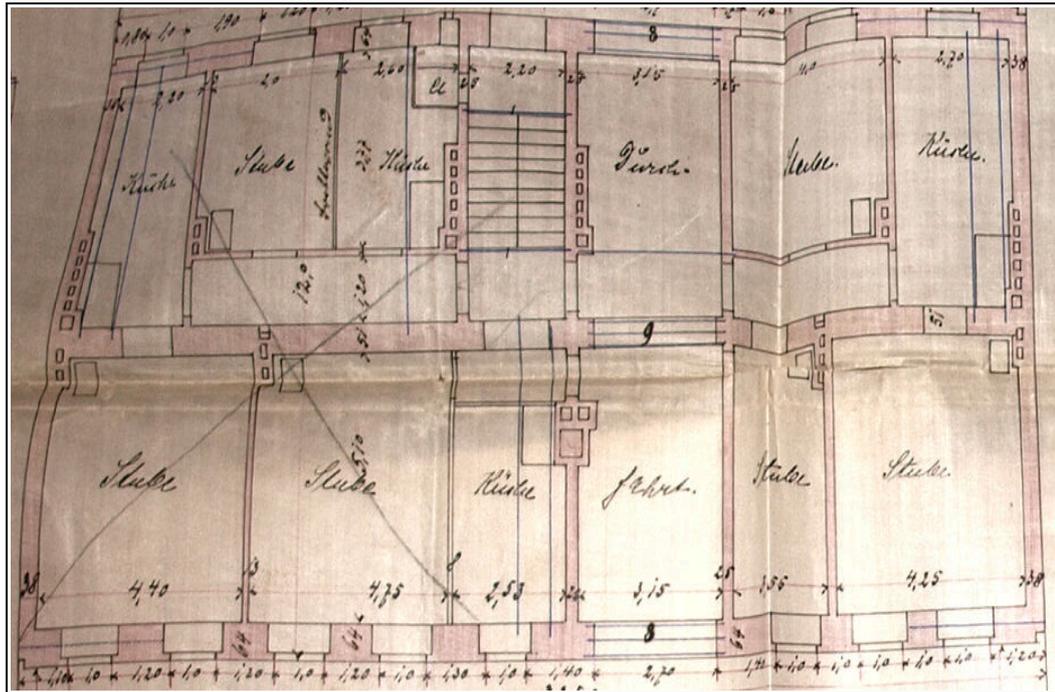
Grundriss Erdgeschoss QG
